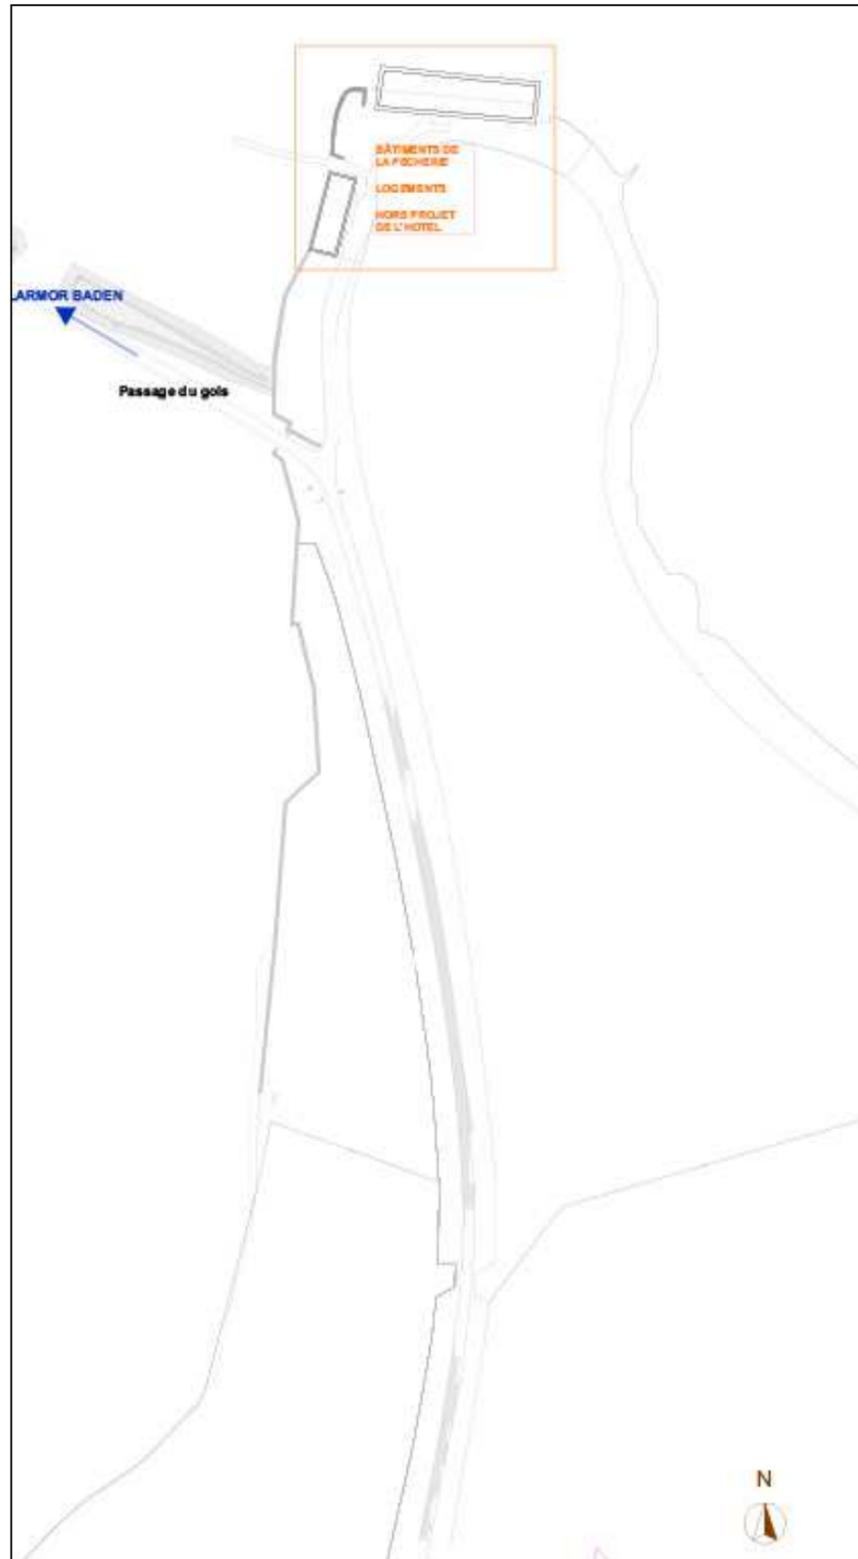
Plan masse du projet (Source : Plans Paumier Architectes Associés)
